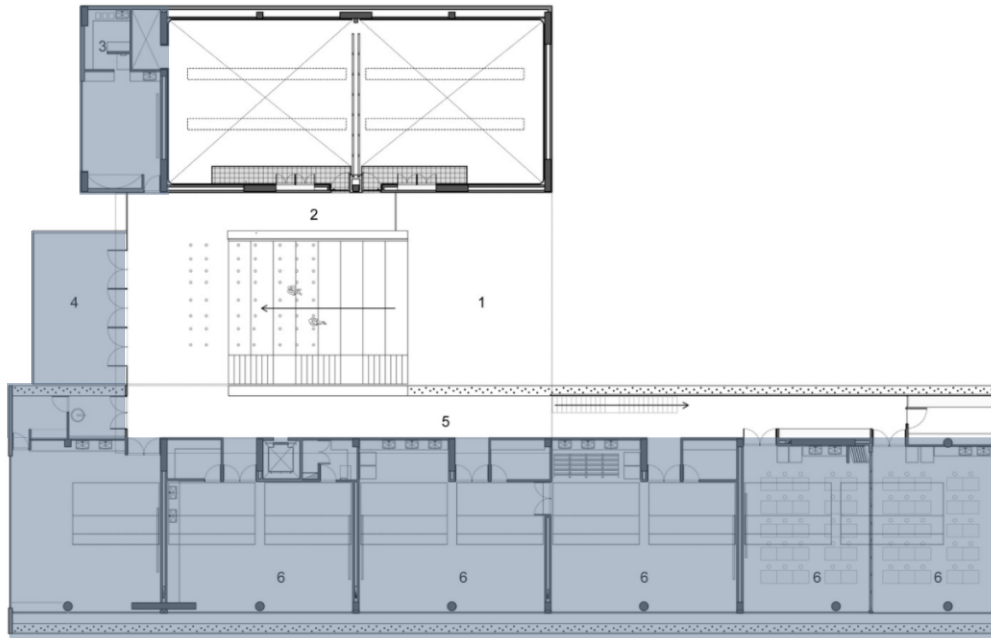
Planta Baixa Segundo Pavimento - Fonte: Archdaily, 2014
